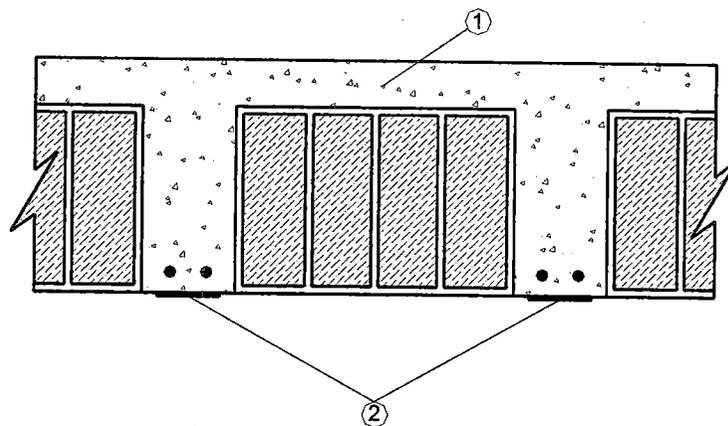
Reforzamiento de losa aligerada mediante ensanche de viguetas.
